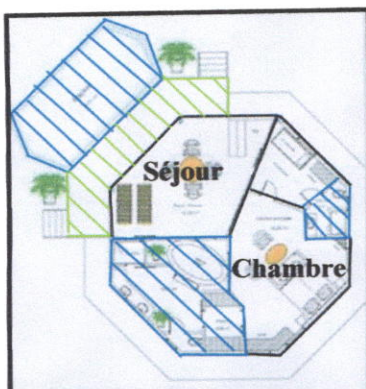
Plan Bungalow type suite (Source: <http://antsanitia.com/mg/room/les-bungalows/>)
